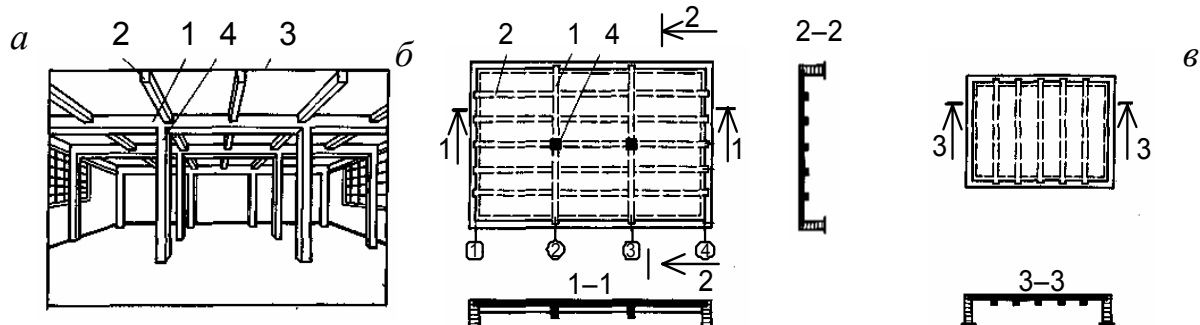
Монолітне ребристе перекриття з балковими плитами
